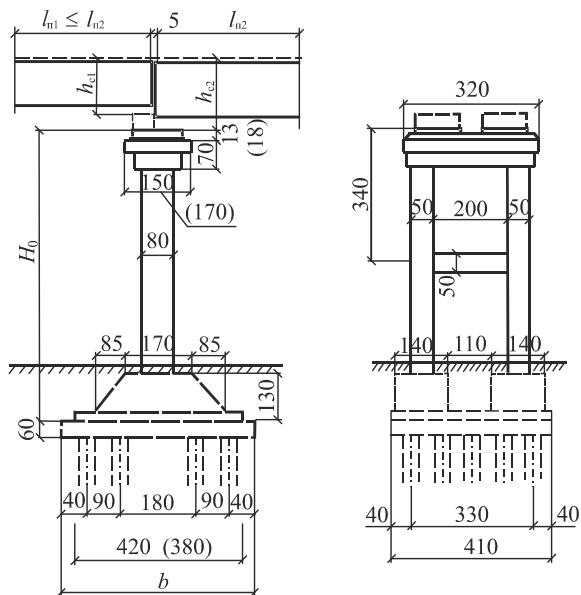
Схема опоры с вариантом свайного фундамента на 20 сваях
